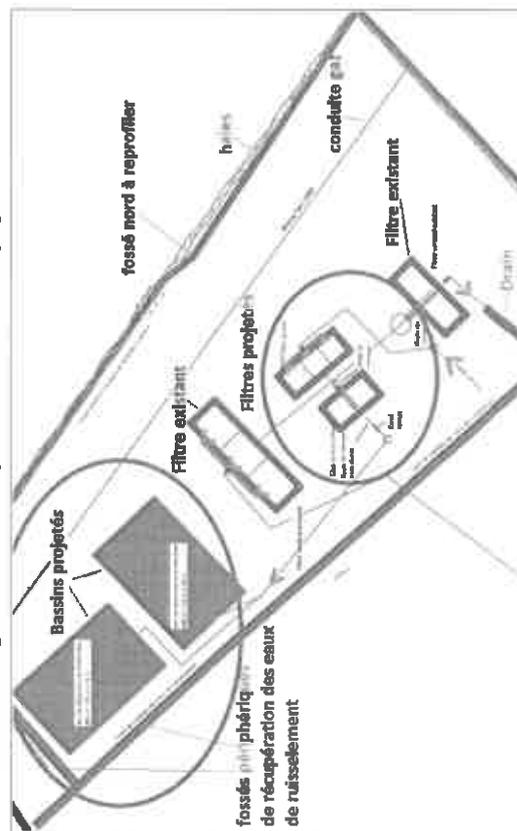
Plan du refoisement vers la STEP, des filtres, et du rejet au drain
